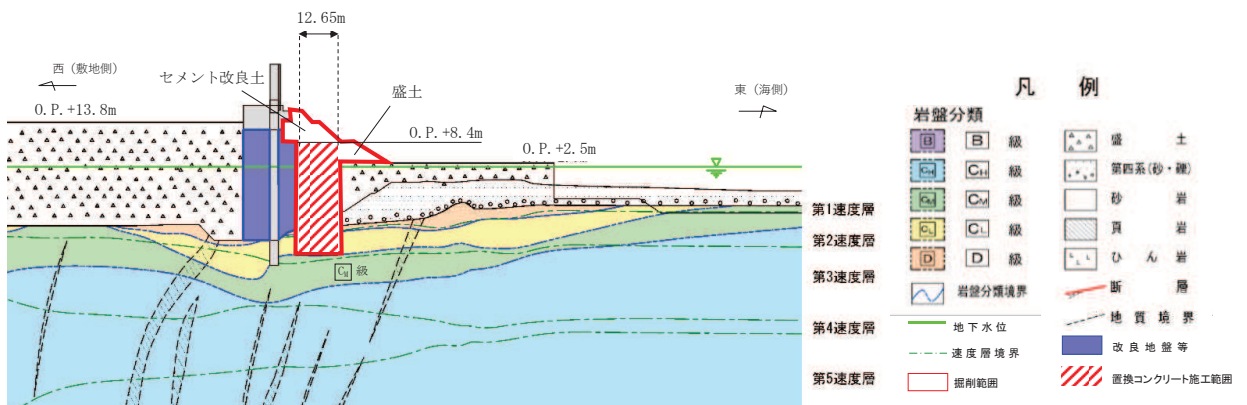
(2) 置換コンクリートの施工範囲図（断面図）
